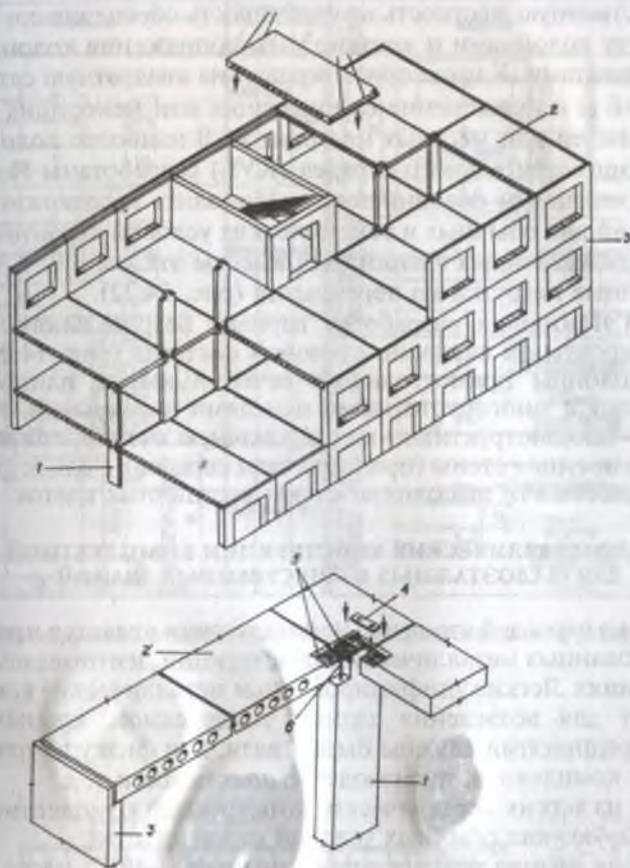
Схема компоновки элементов и опорные узлы безригельного каркасно-универсального каркасно-стеновой системы:
